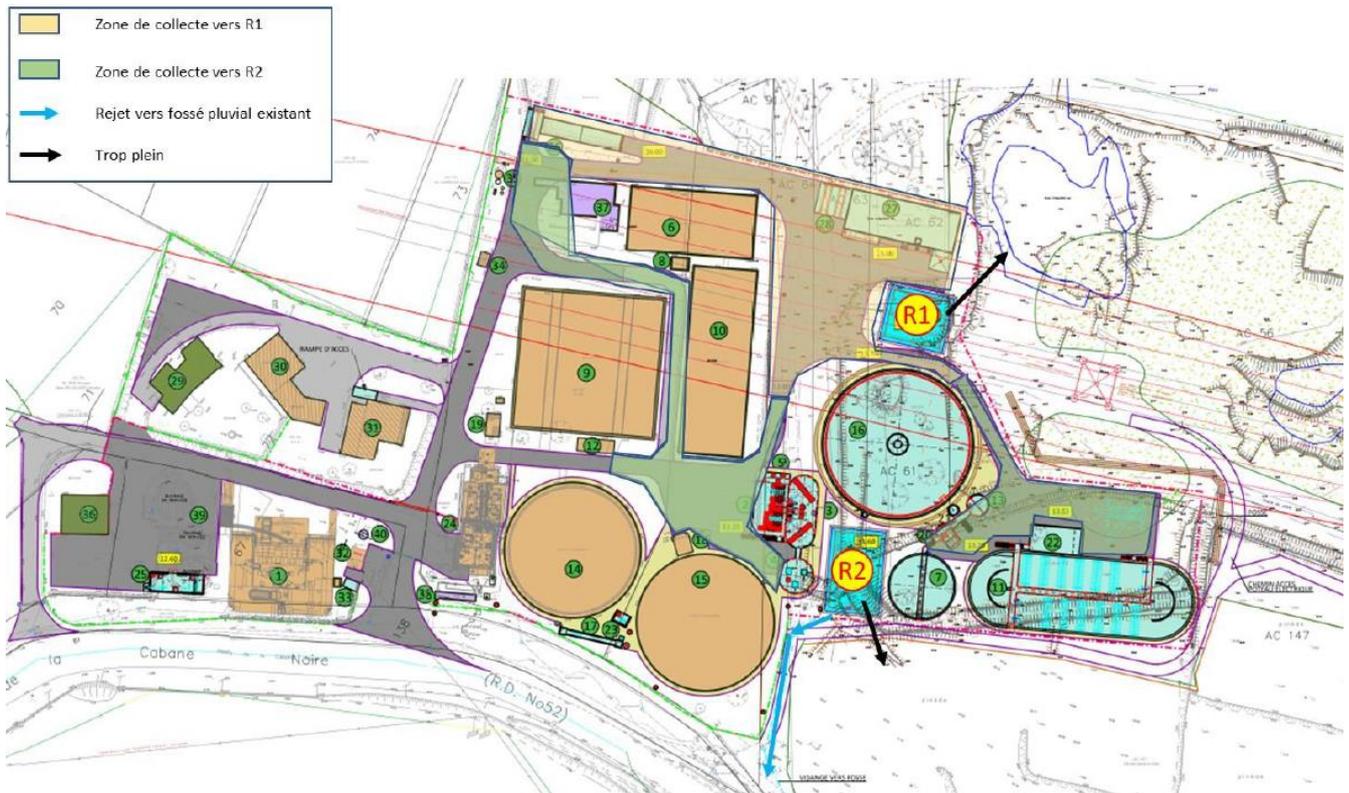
Principes de collecte et rétention des eaux pluviales sur le site de l'extension
